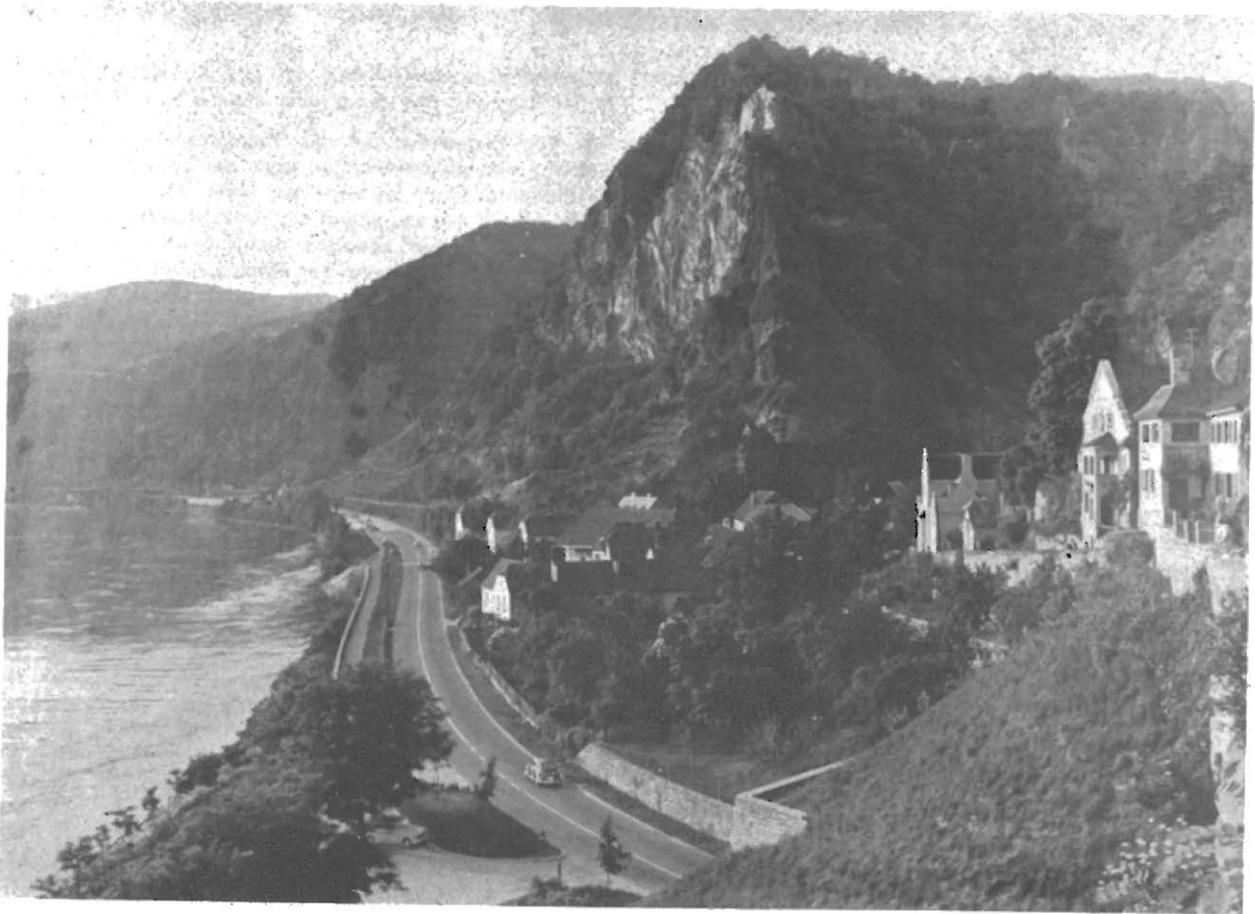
Dürnstein, Wachaustraße (Foto des Verfassers)
